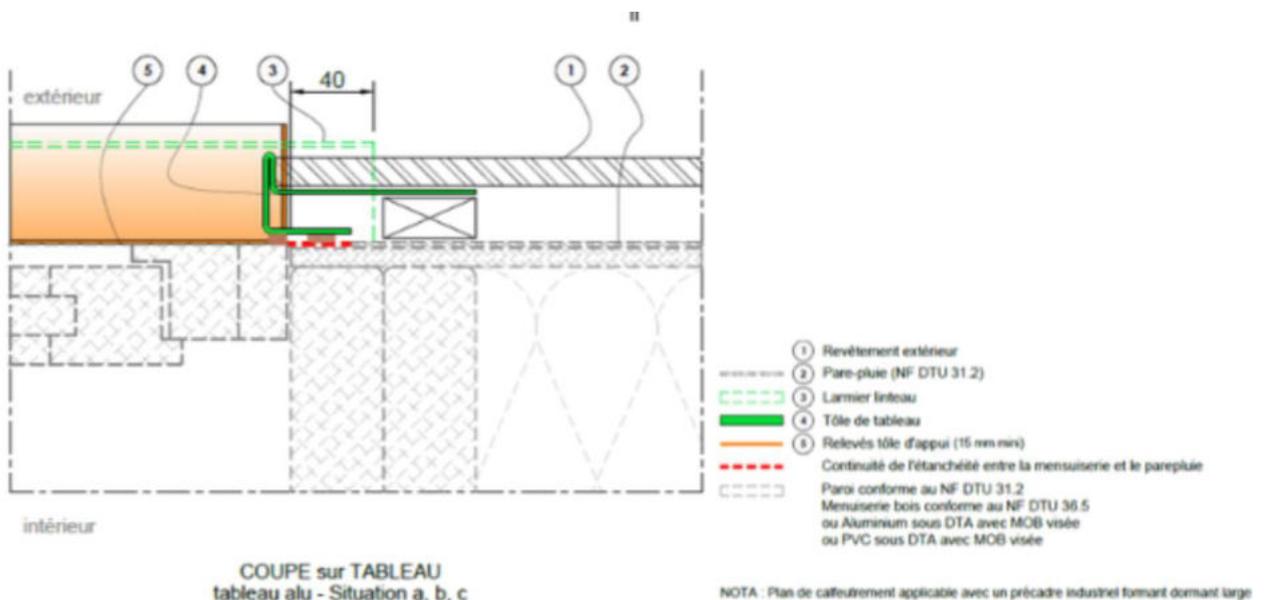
Pose sur COB - Coupe sur tableau de baie
